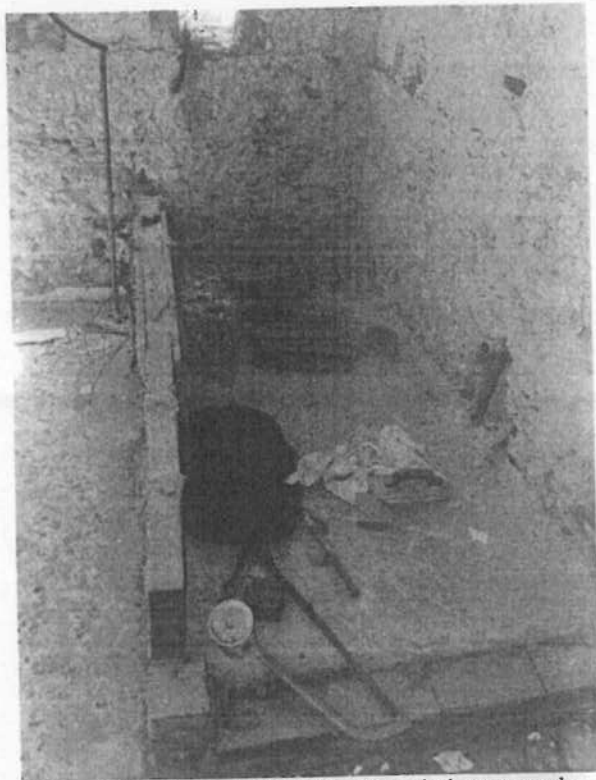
Imposta di tramezzatura al piano secondo.
